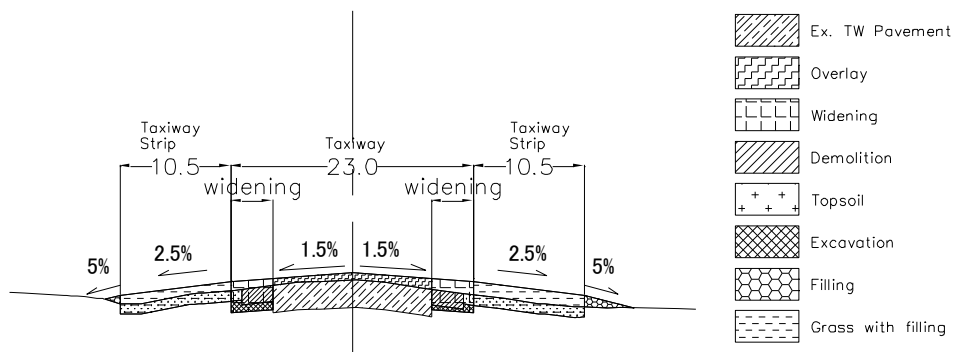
TW-C 標準横断面図 Sta. 1+00
